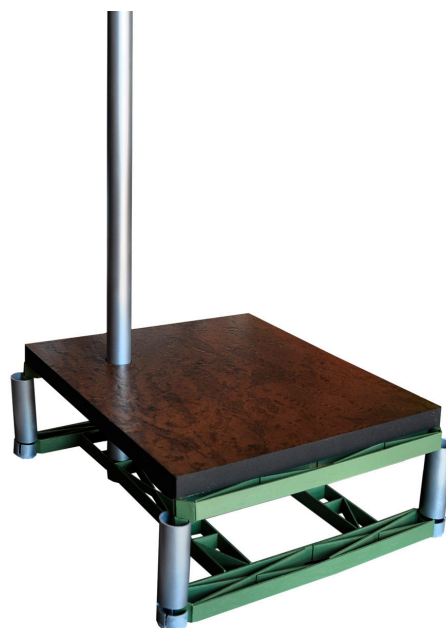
Maqueta de sistema de pavimento sobrelevado para espaço de exposição. Encaixe de estruturas. Registo de Salomé Arieira.
